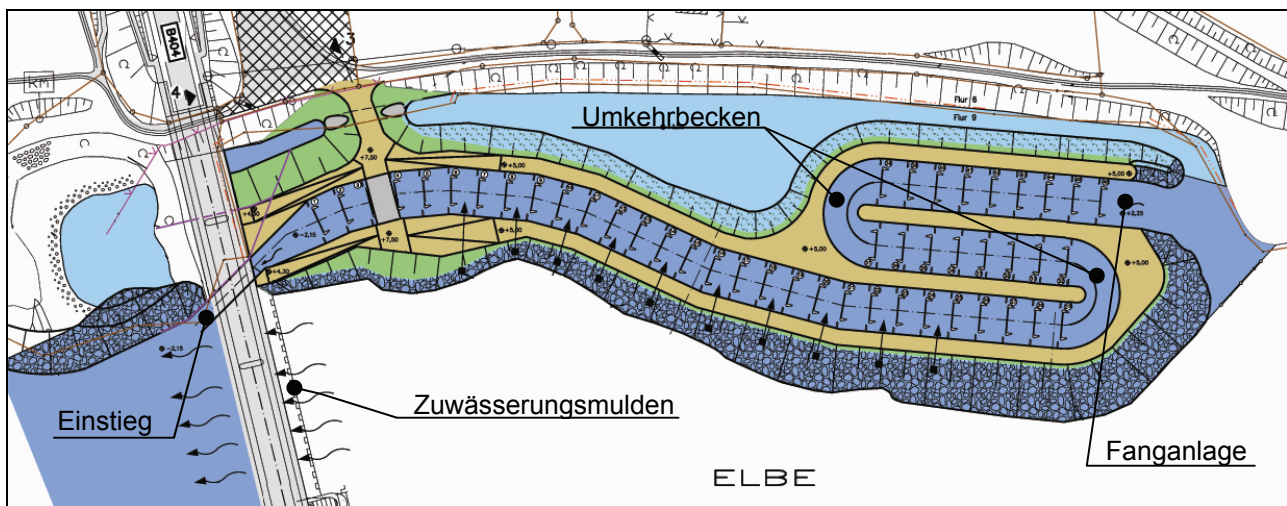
Plan des Doppelschlitzpasses am Wehr Geesthacht (Quelle: KED Ingenieure)
